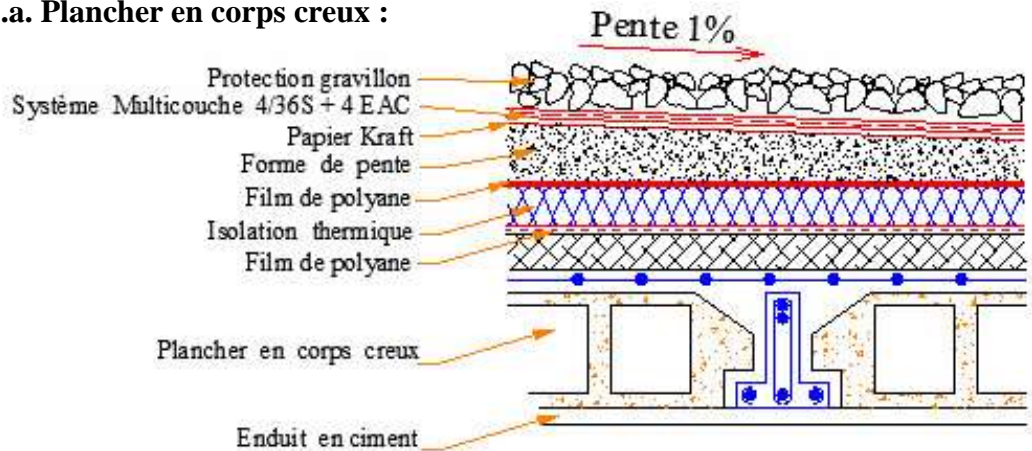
Coupe verticale du plancher terrasse inaccessible (corps creux)
